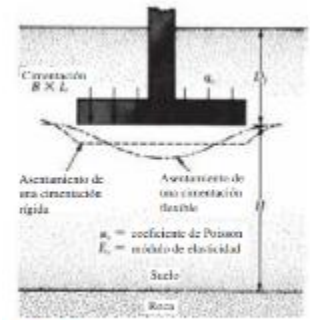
Asentamiento elástico de cimentaciones flexibles y rígidas
